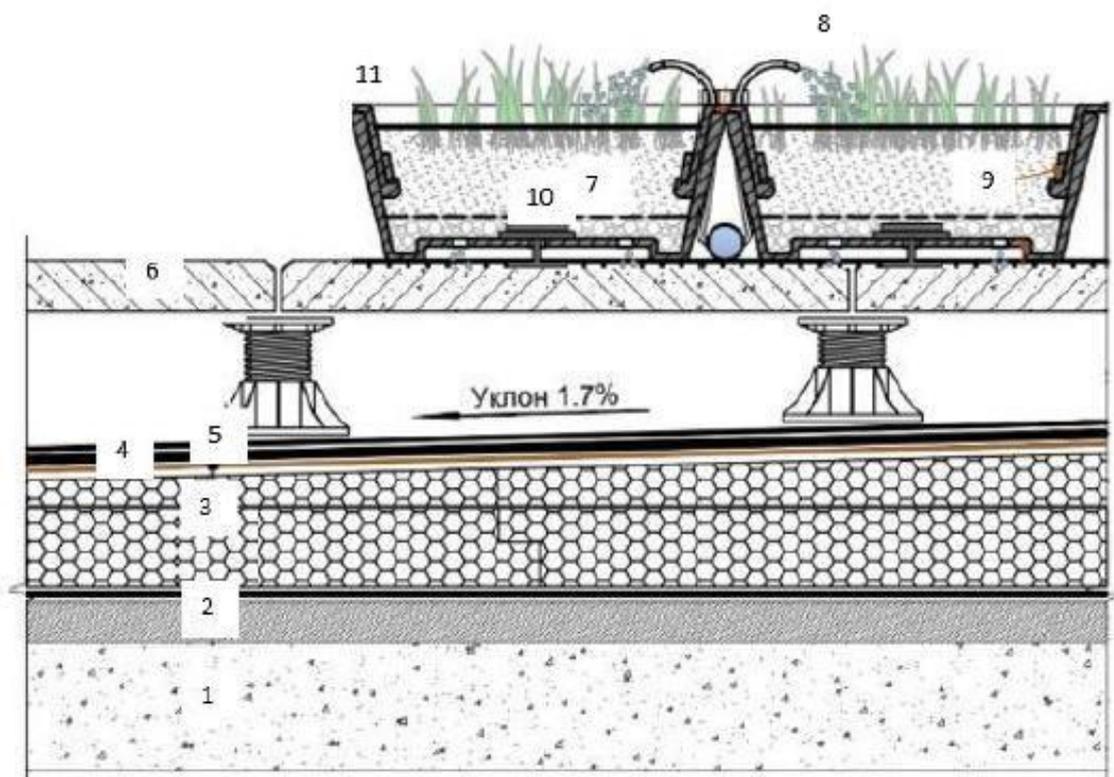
Схематичне зображення конструкції покрівлі з модульною
